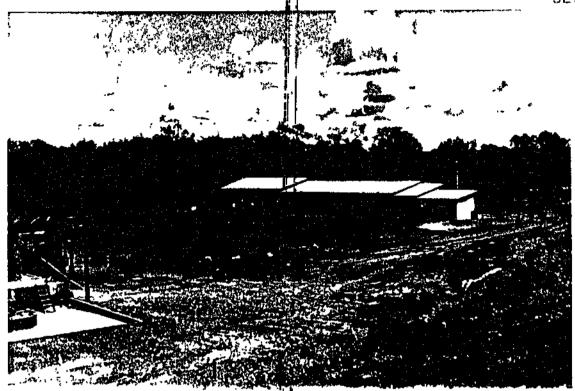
Detalhes da infraestrutura. La foto, no primeiro plano lado esquerdo, a lagoa de captação de água para a usina de heneficiamento. No segundo plano a estrutura central de oficina, alojamentos e sanitários.
